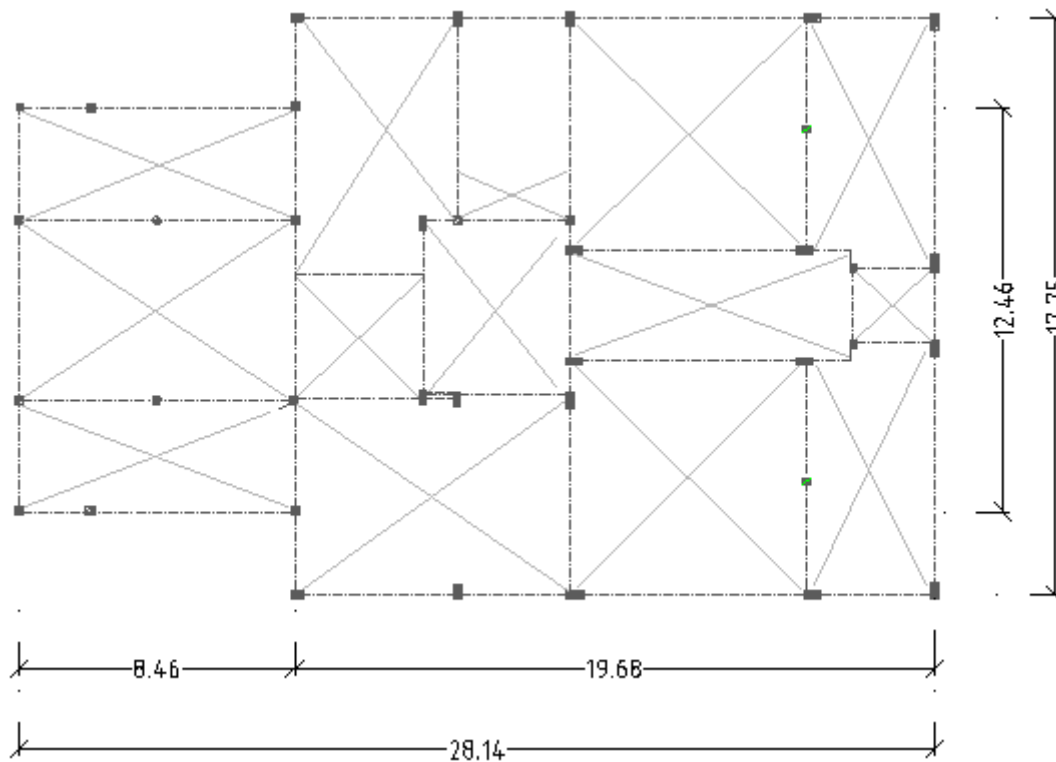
Planta do piso 1 (rés-do-chão). (Adaptado de [Nível, C.; 2009])
